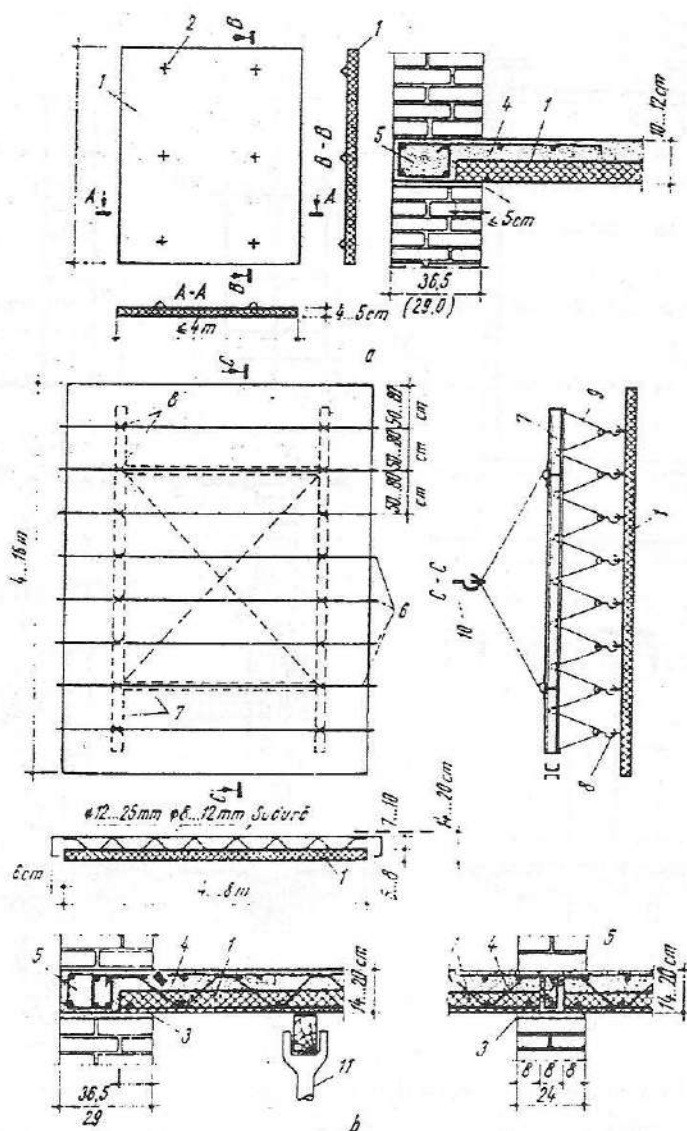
Planșee cu predale prefabricate din beton armat:
